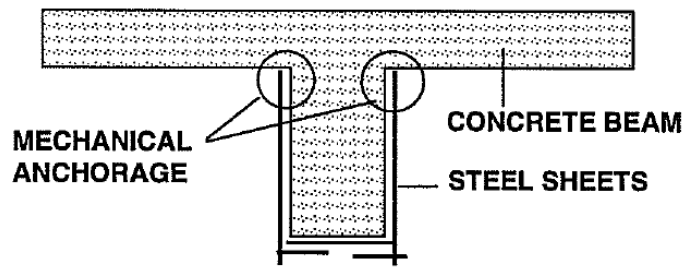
Encamisado de vigas con planchas de acero (Aguilar et al., 1996).
